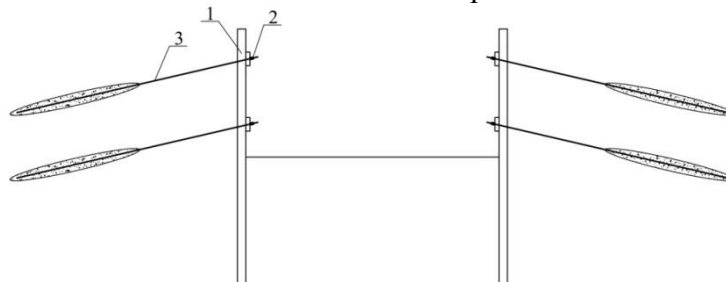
Крепление стен глубокого котлована грунтовыми анкерами:
